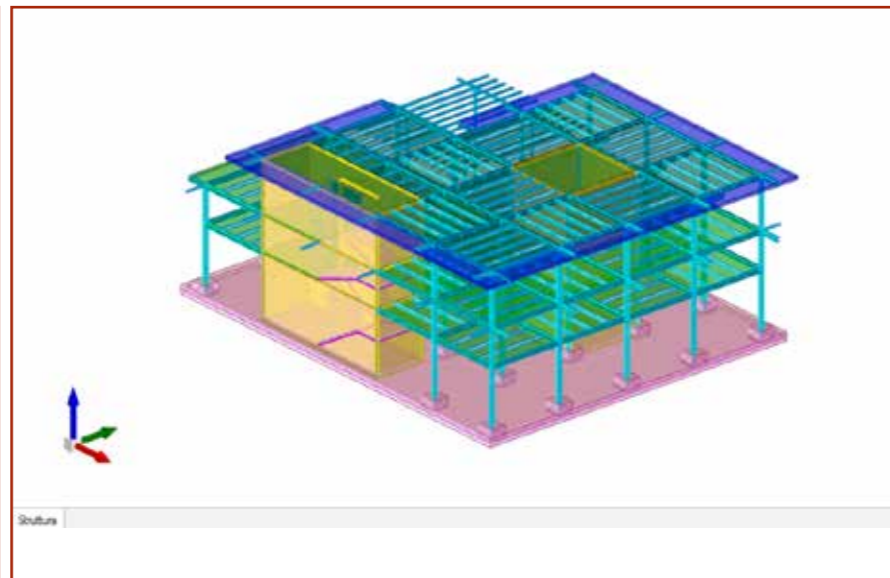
Rappresentazione generale della struttura - vista 3.png
